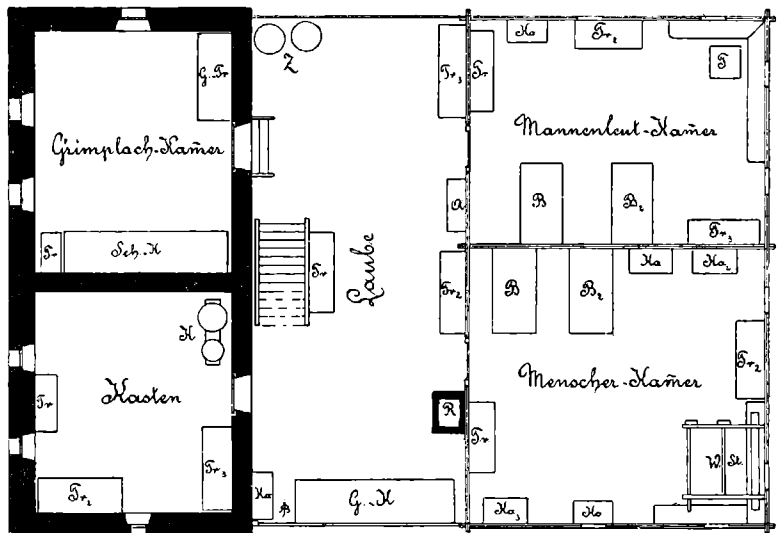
Grundriss des Obergeschosses des Hatz-Hauses.
